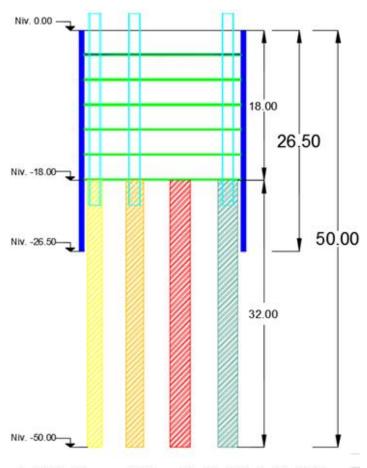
, Corte Transversal: Sotanos, Pilas, Muro Milán, Puntales Metálicos
